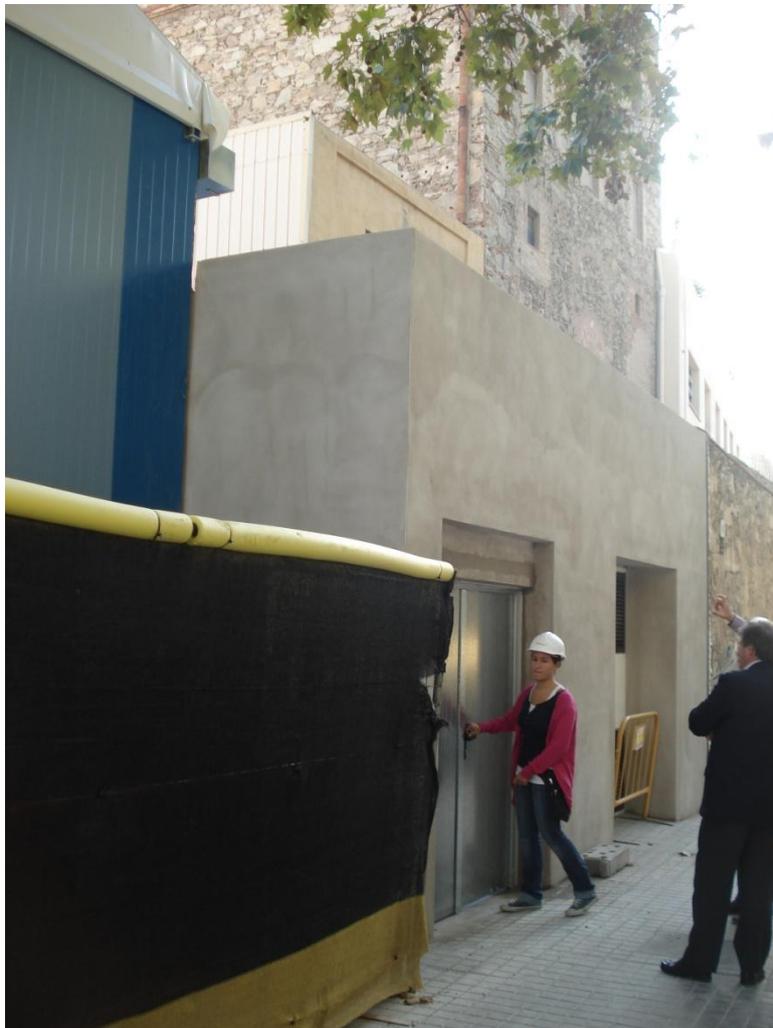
6 Puerta acceso exterior a zona de basuras
